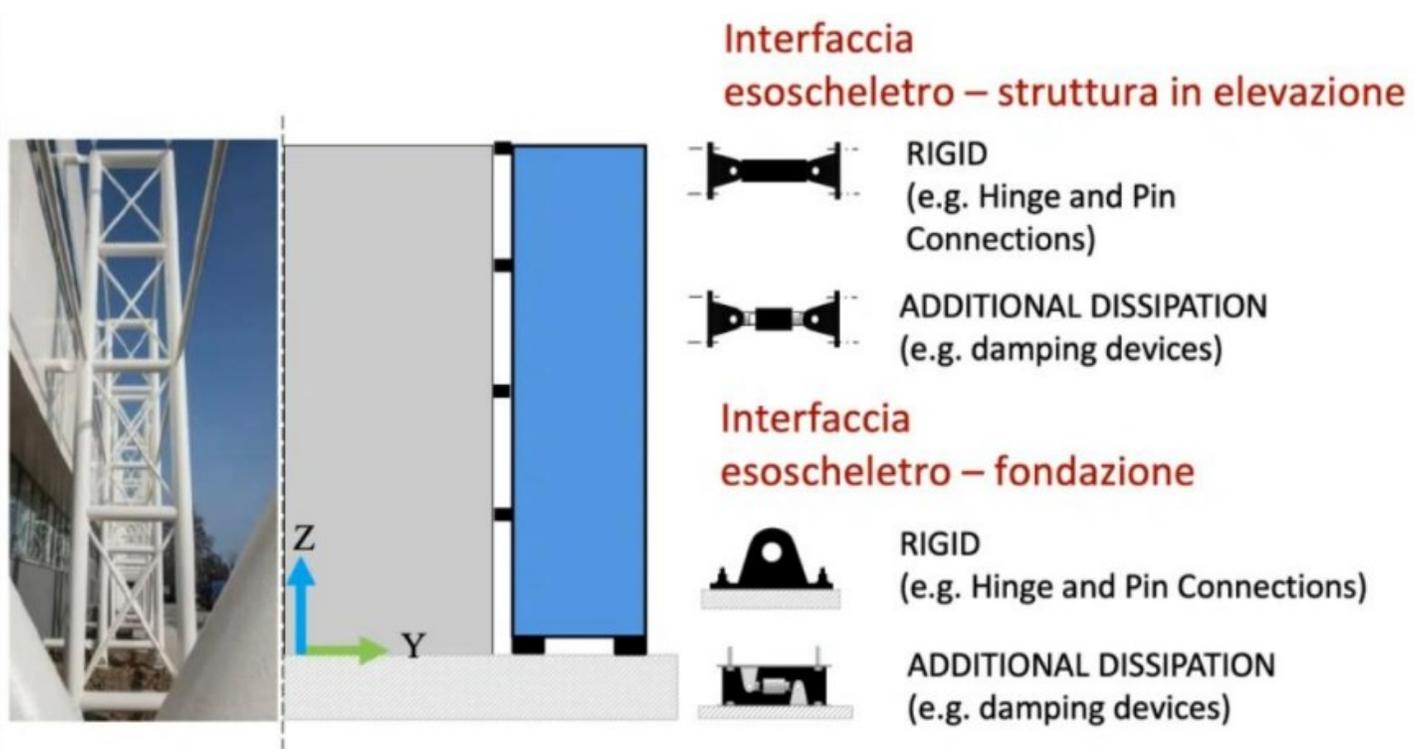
Interfaccia esoscheletro con struttura in elevazione e fondazione
